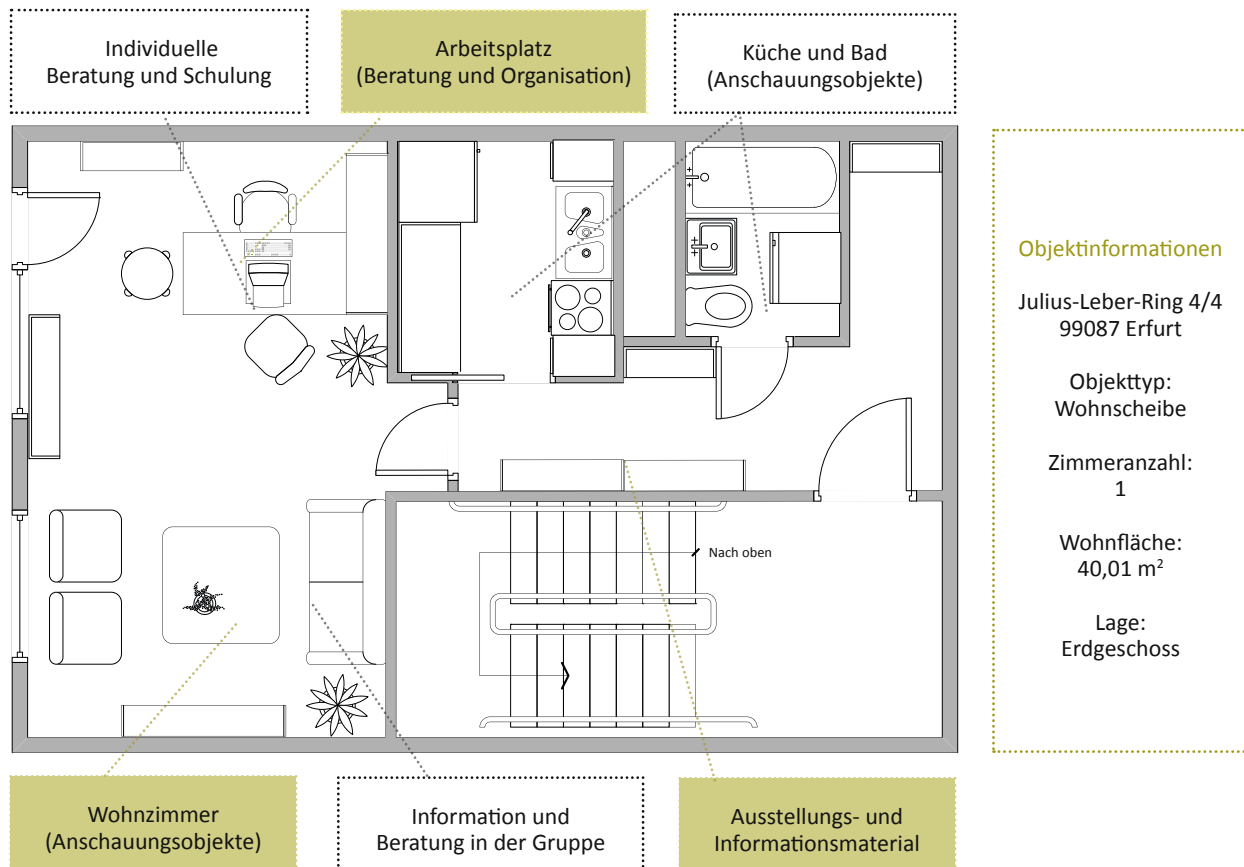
Grundriss der Modellwohnung im Erfurter Stadtteil Roter Berg (Quelle: eigene Darstellung 2018)
